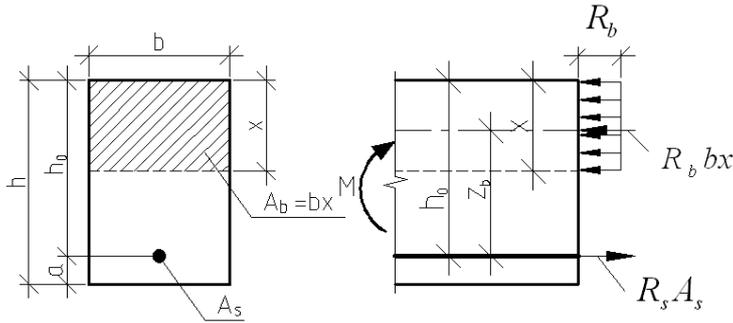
Прямоугольное сечение с одиночной арматурой и схема усилий
